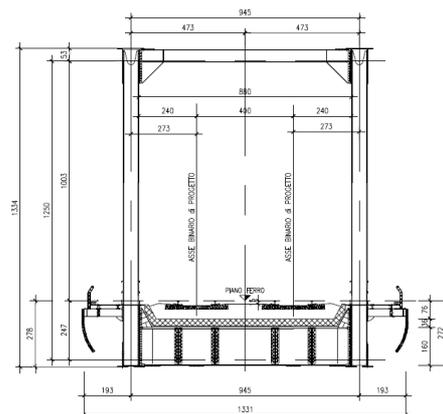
Impalcato in acciaio - cls: sezione trasversale
